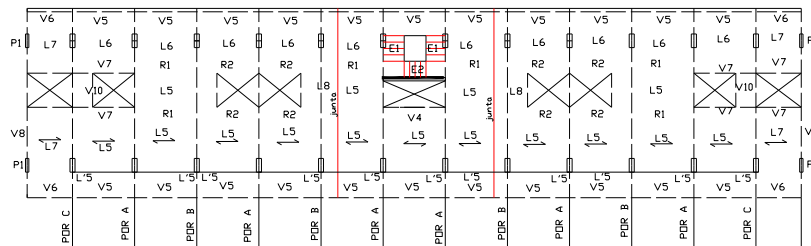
Planta estrutural dos andares inferiores (2º, 4º, 6º e 8º) [40].
